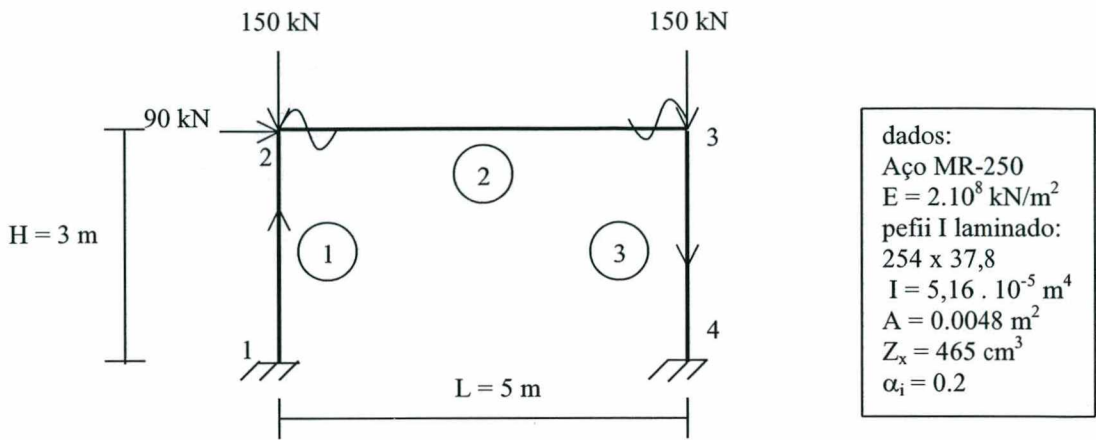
Pórtico plano com carregamento nodal três vezes superior e seções mais rígidas com “molas” aplicadas somente na viga.
